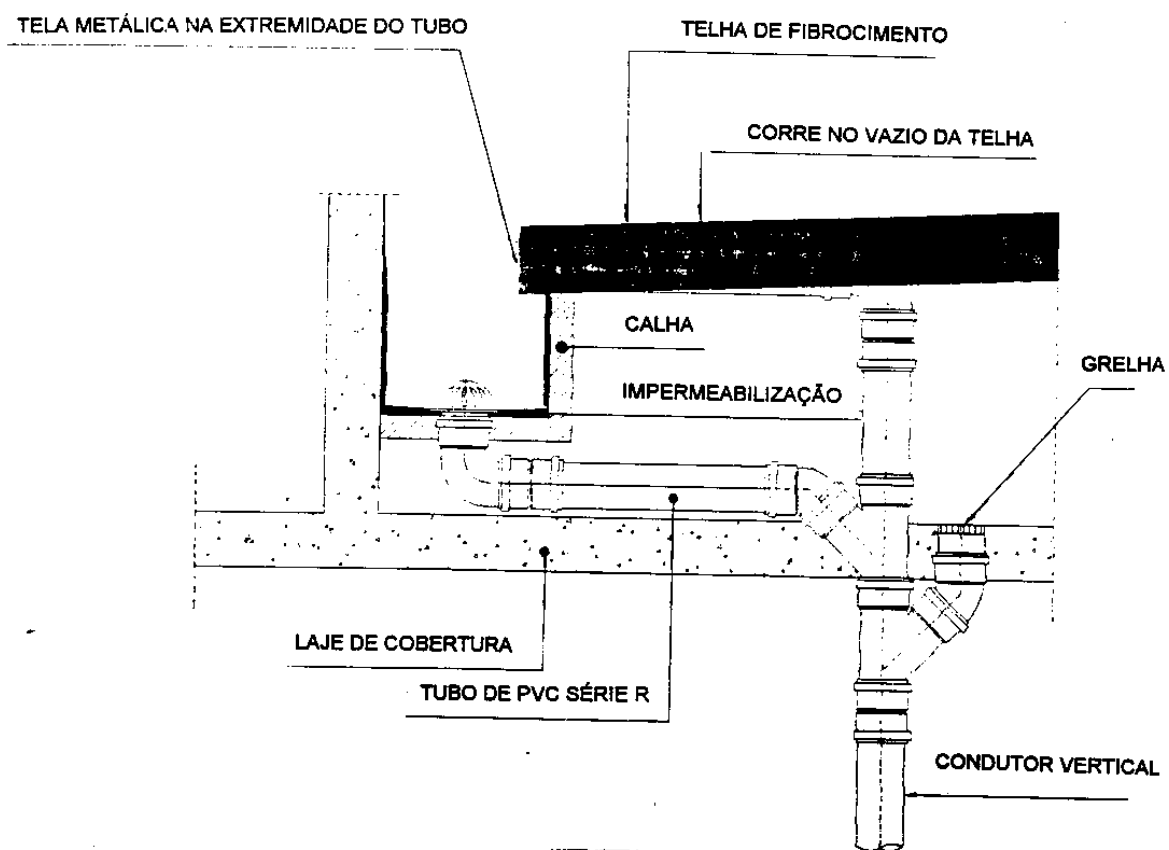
Detalhe de ligação calha - condutor vertical.
